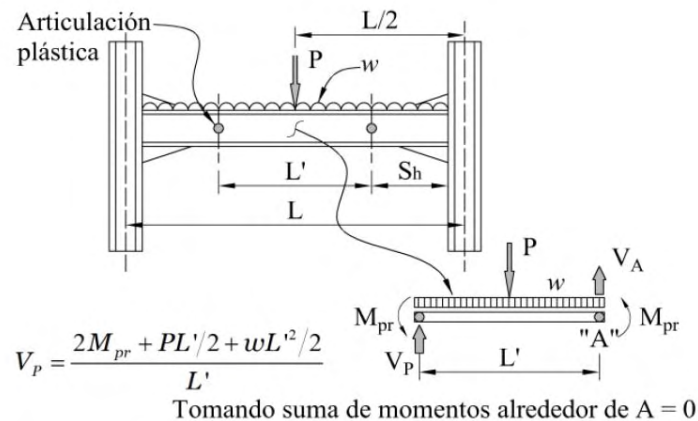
Equilibrio de la viga, figura 12.1.1 (NTC-DCEA, 2017)
